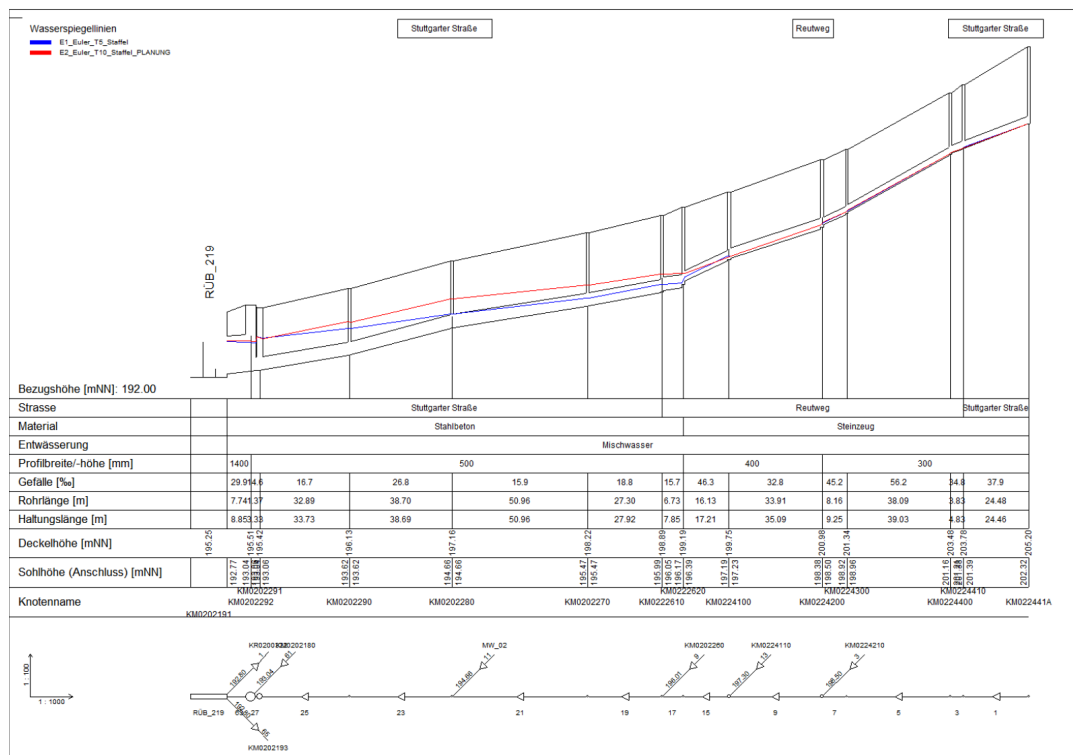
Hydraulischer Längsschnitt des Gesamtsystems mit Stuttgarter Straße, Reutweg und Eichendorffstraße. Große Darstellung siehe Anlage.
